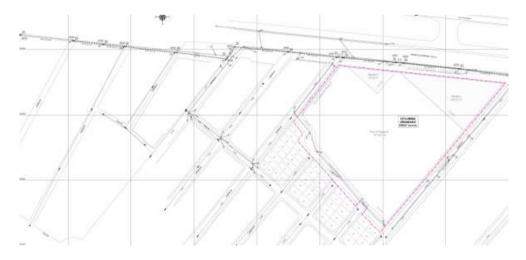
Red de Alcantarillado Sanitario, Plan Parcial Cartón Colombia Fuente. Elaboración Propia
